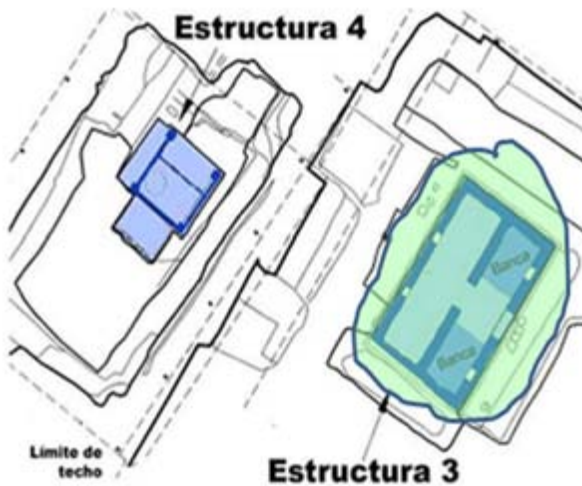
Plano tomado de Plan de Manejo Joya de Cerén. Getty Institute, FUNDAR.
